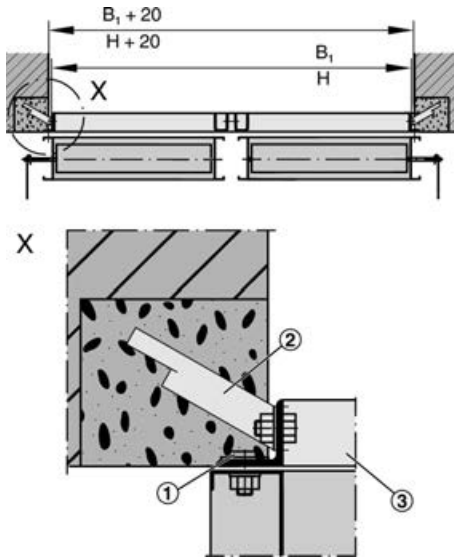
Installation murale avec contre-cadre (construction en acier/acier inox), largeur subdivisée
